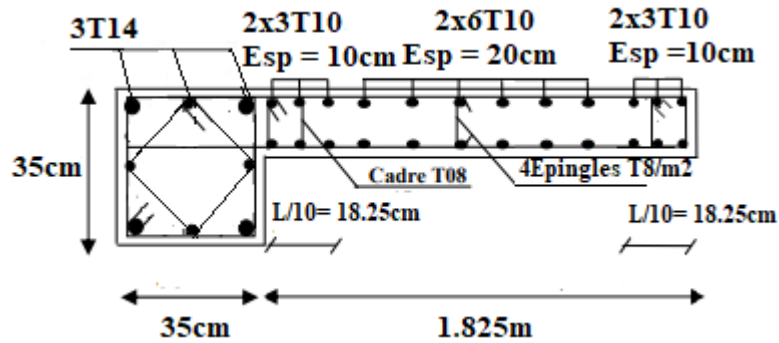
Dessin de ferrailage des voiles V1 et V'1 du 2<sup>ème</sup> étage
